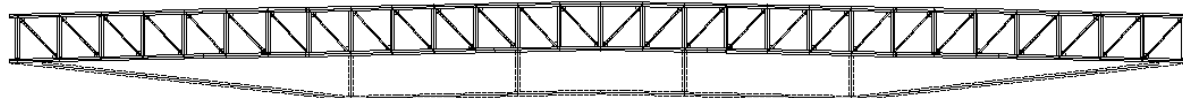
Vista esquemática do sistema estrutural completo do vão central
